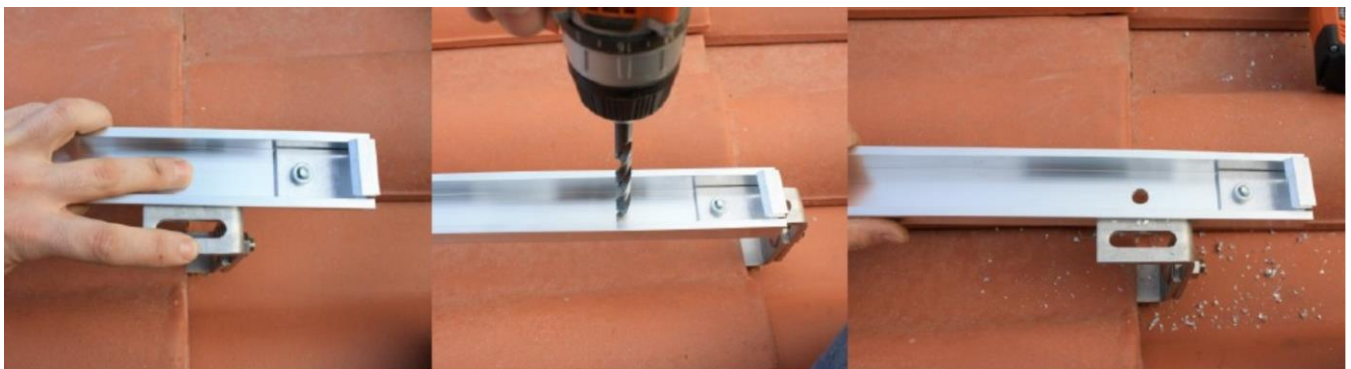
Exemple de montage du kit de fixation pour 1 capteur horizontal sur toiture en tuiles à fort galbe
